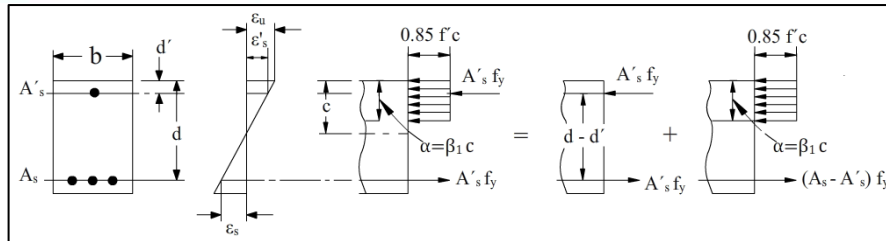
Esfuerzo y deformación de una viga doblemente reforzada.
